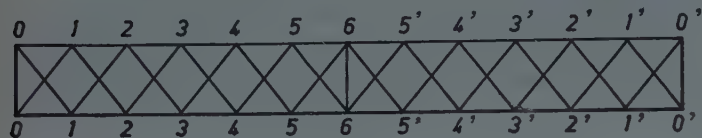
Poutre à treillis en forme de losanges... avec barre verticale centrale.
